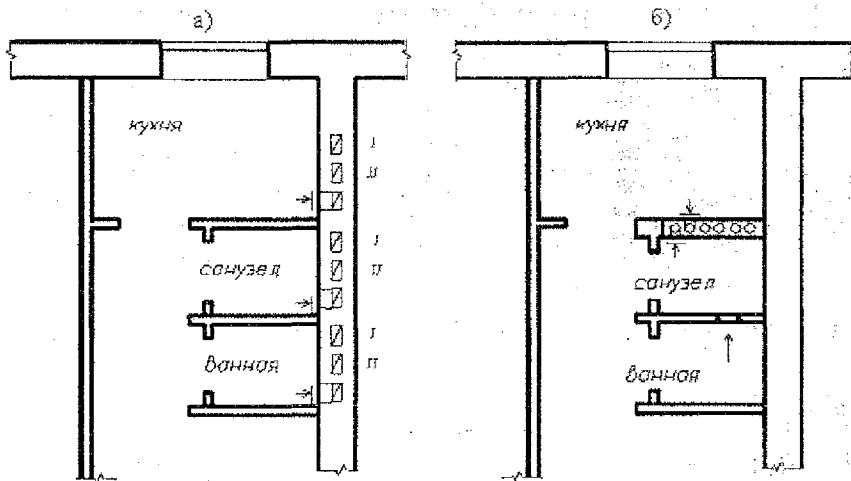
Устройство вентиляционных каналов: а) во внутренних кирпичных стенах; б) с использованием вентиляционных панелей
